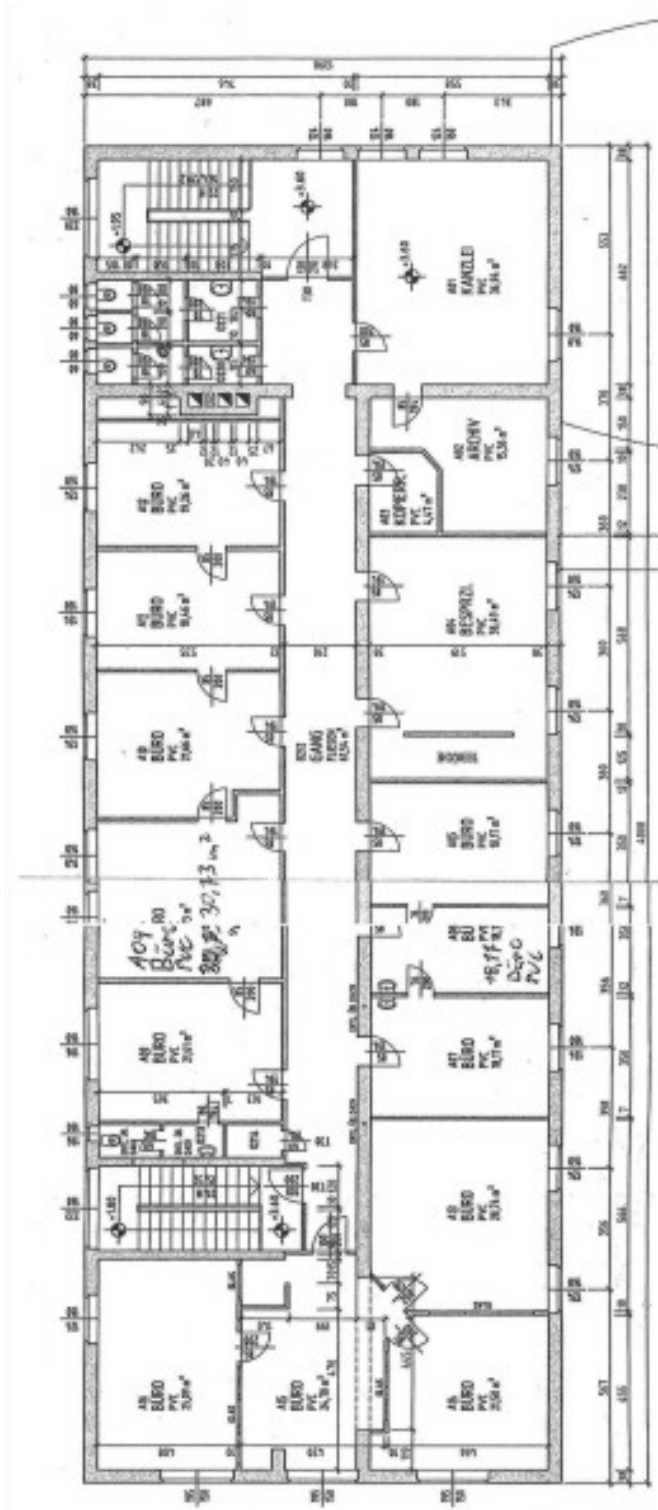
Bestandsplan LFS: Grundriss Bürobereich, 1stes Obergeschoss
